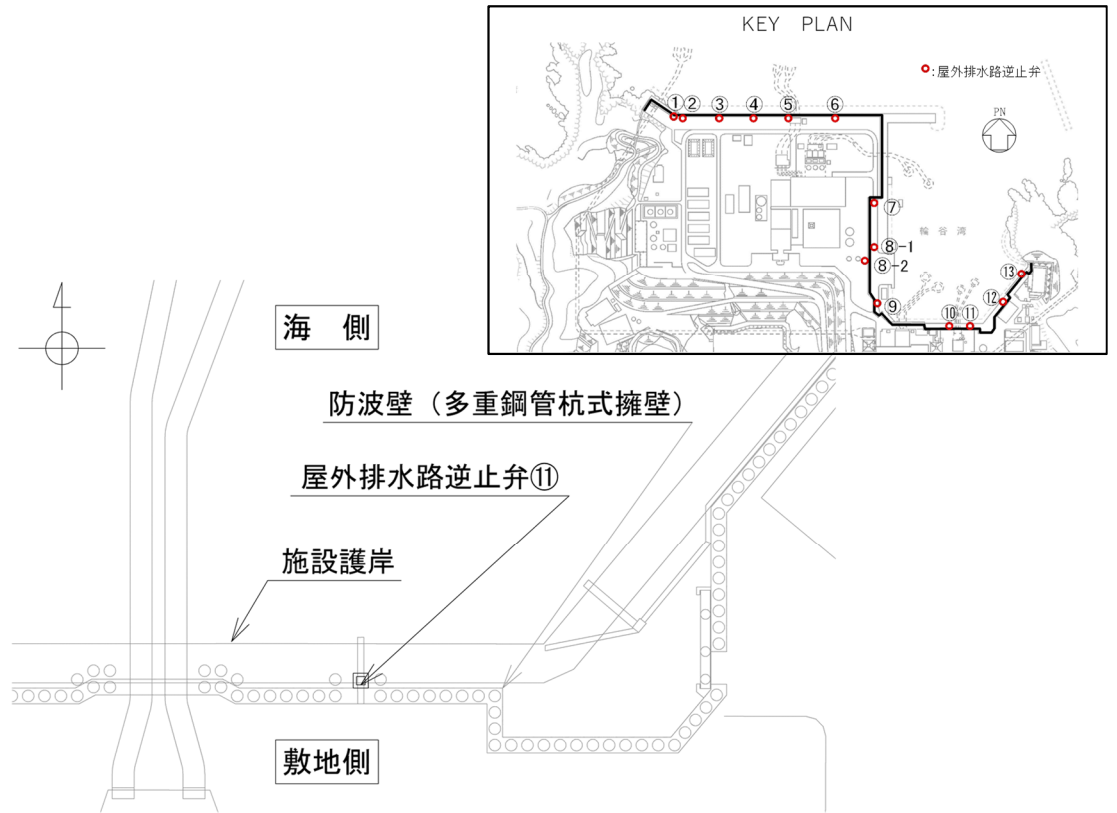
(1) 屋外排水路逆止弁⑪平面図
